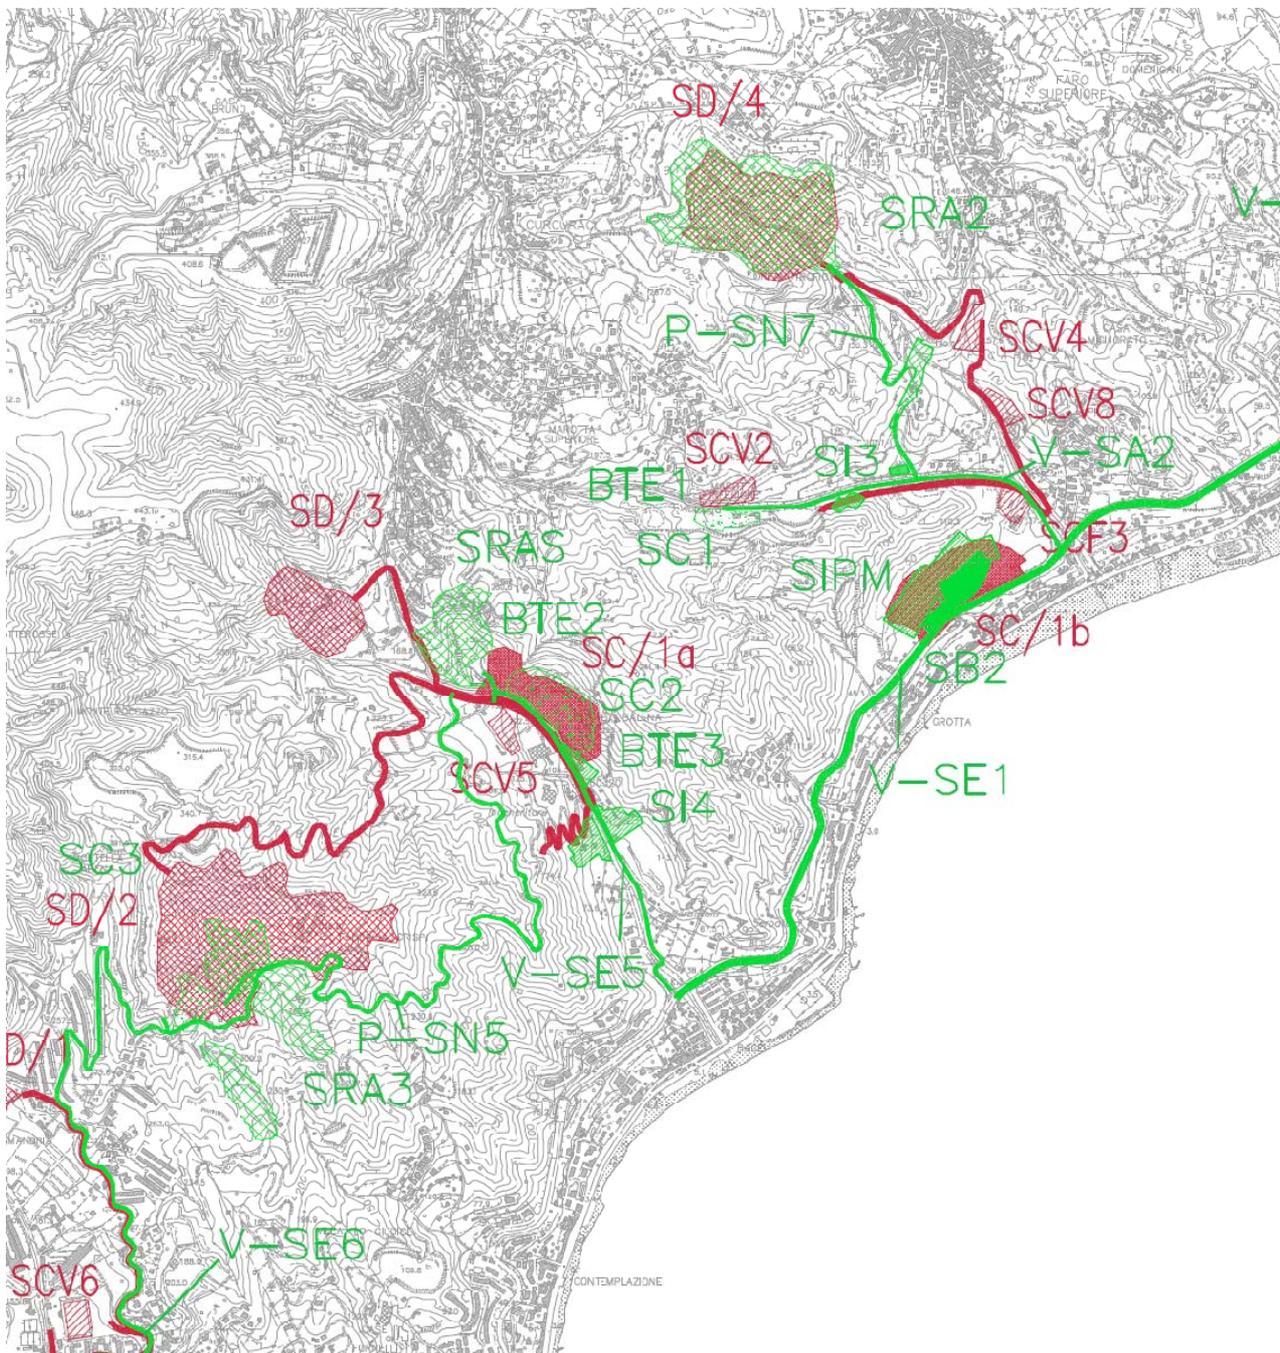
Stralcio della planimetria di confronto della cantierizzazione tra PP (aree in rosso) e PD (aree in verde) per il tratto centrale in cui si insediano cantieri per il collegamento stradale e ferroviario
